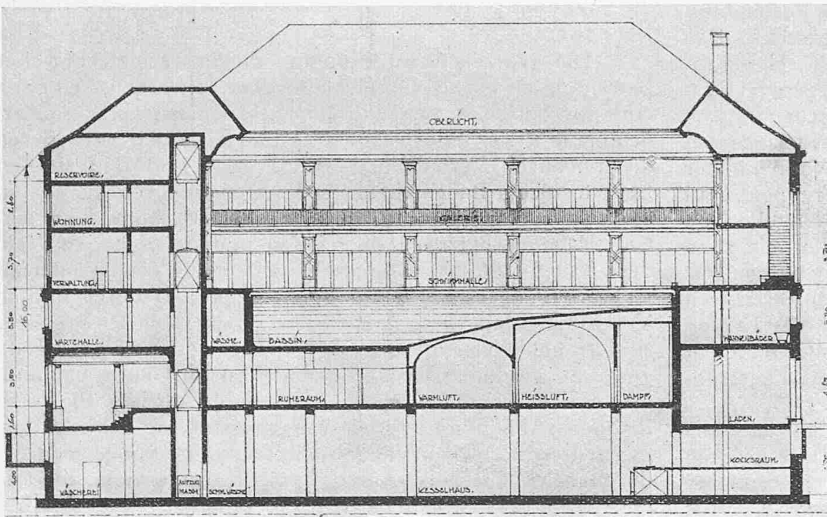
und 4. Grundrisse vom I. und II. Stock, 1 : 500. — Abb. 5. Längsschnitt 1 : 400.
